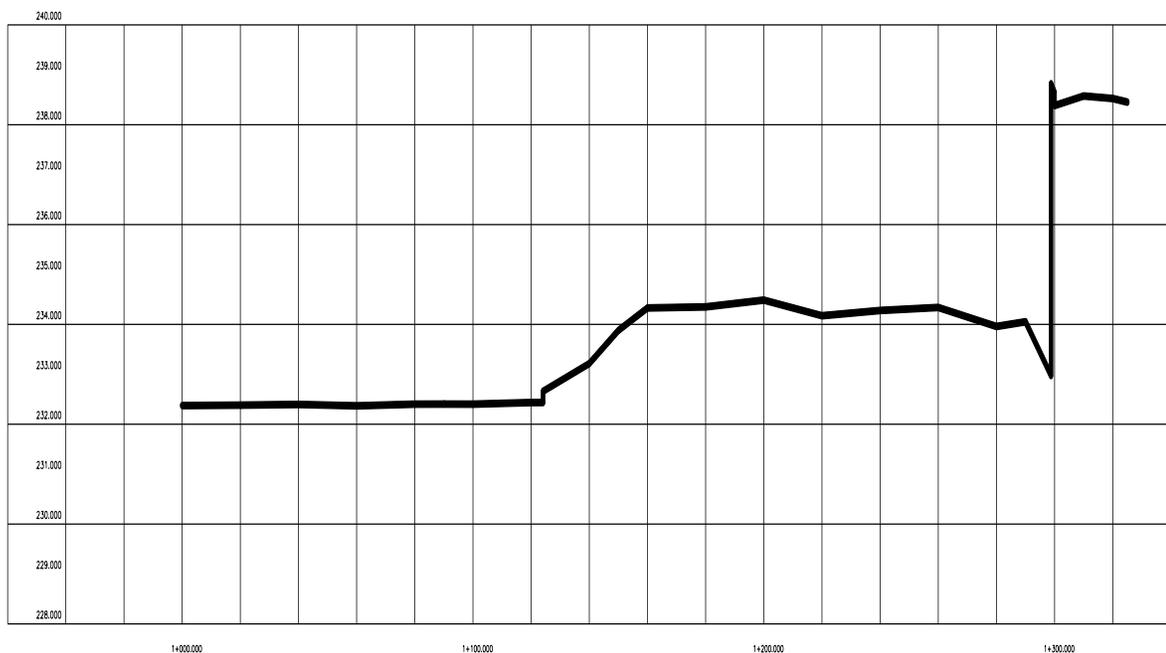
Perfil del Terreno, Eje – C (Av. Plan de Muyuguarda)
